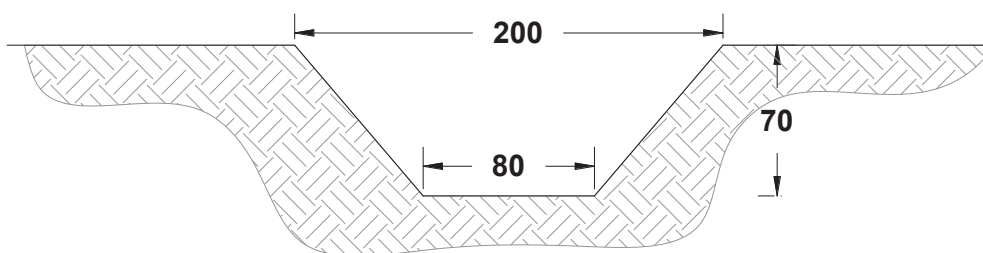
Sezione di progetto fosso Chiaruccia a valle del cavalcavia di Via Campanella
